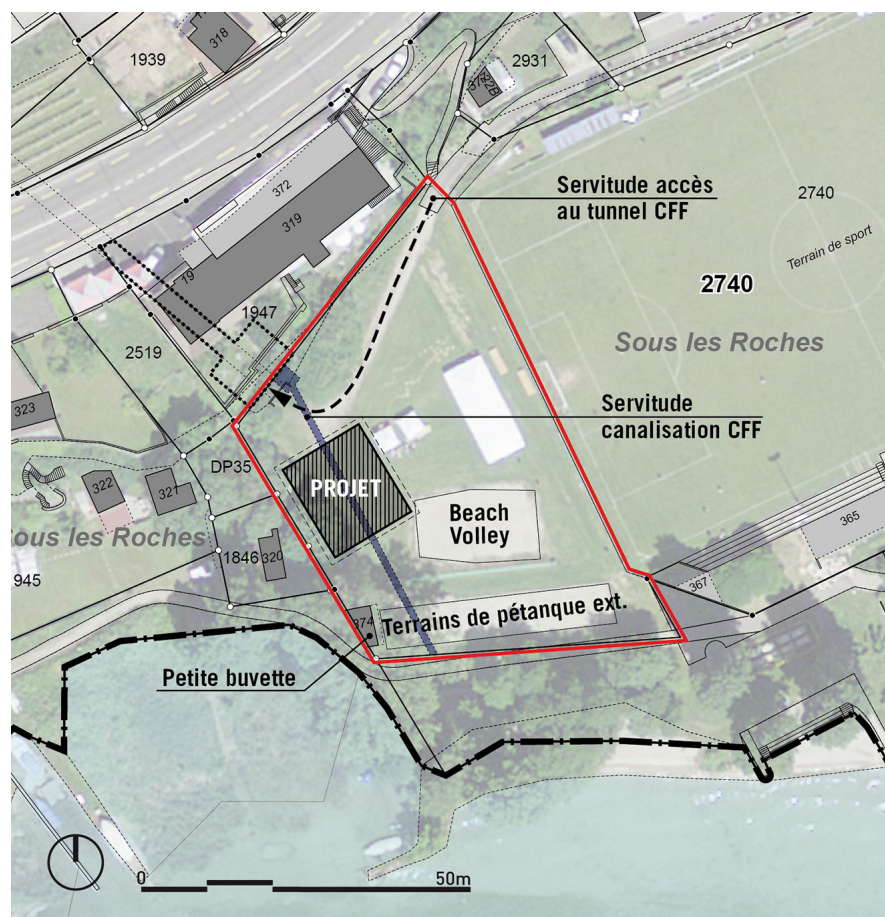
Plan du projet architectural (source : Gaille Constructions SA)
